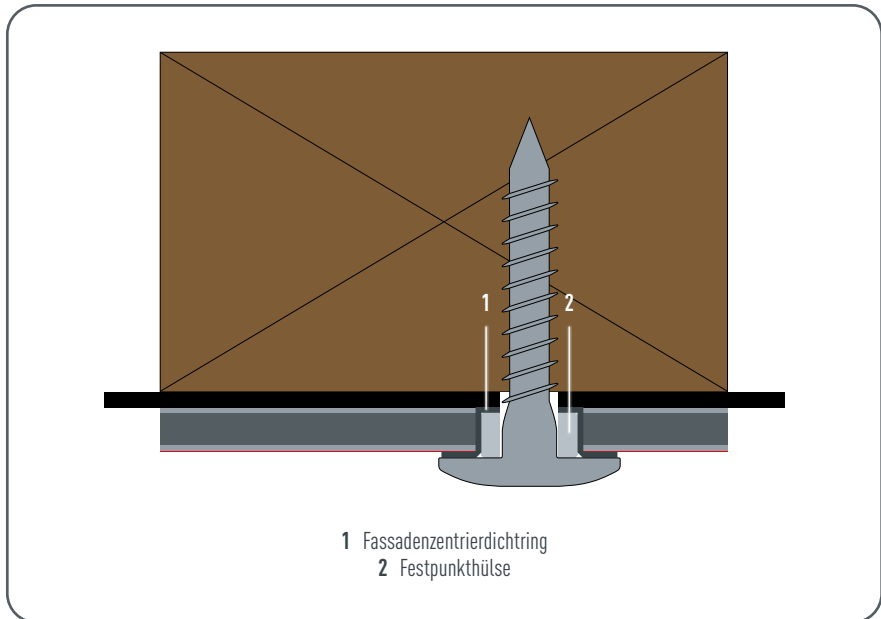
• Fixpunkt auf Holzunterkonstruktion
